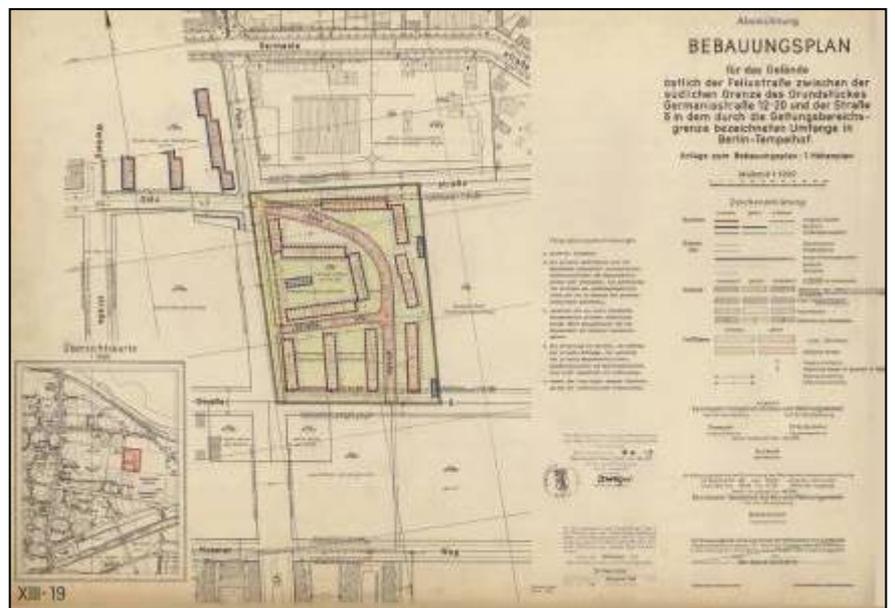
Bebauungsplan XIII-19 (ebda.)
